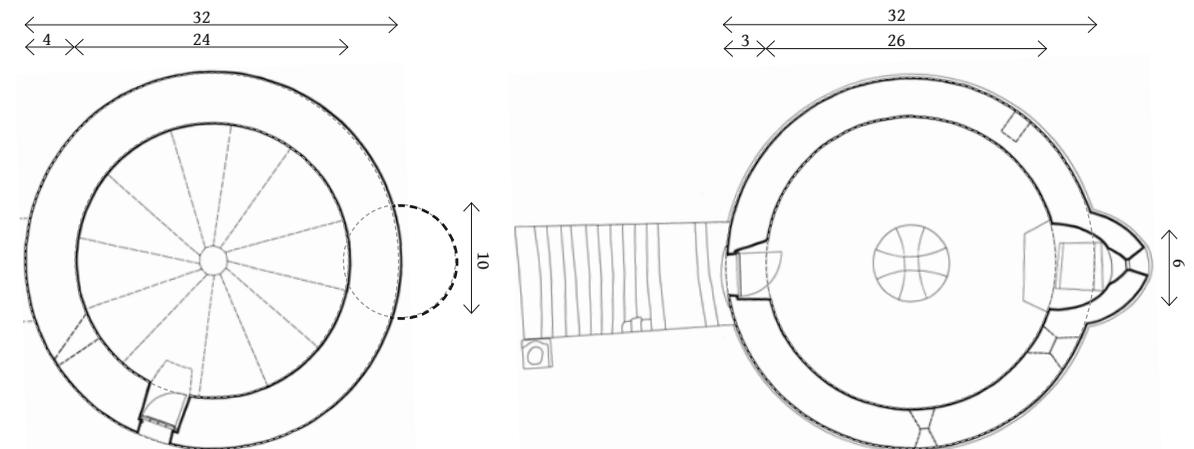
Grundrisse mit den kodierten Hauptmaßen in Fuß. CA 2016.
